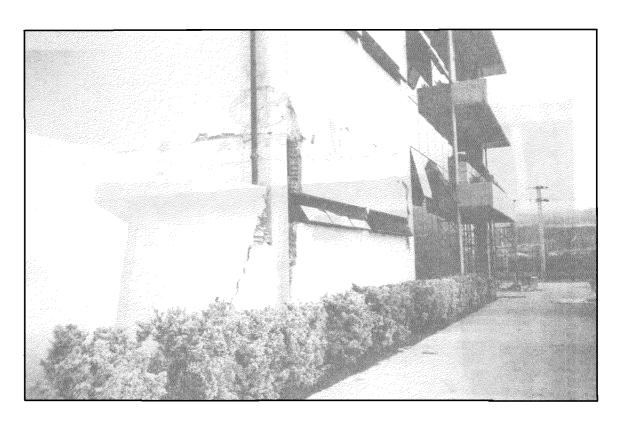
Efectos en la tabiquería de fachada en la sede de la Planta Toyota, Cumaná.
